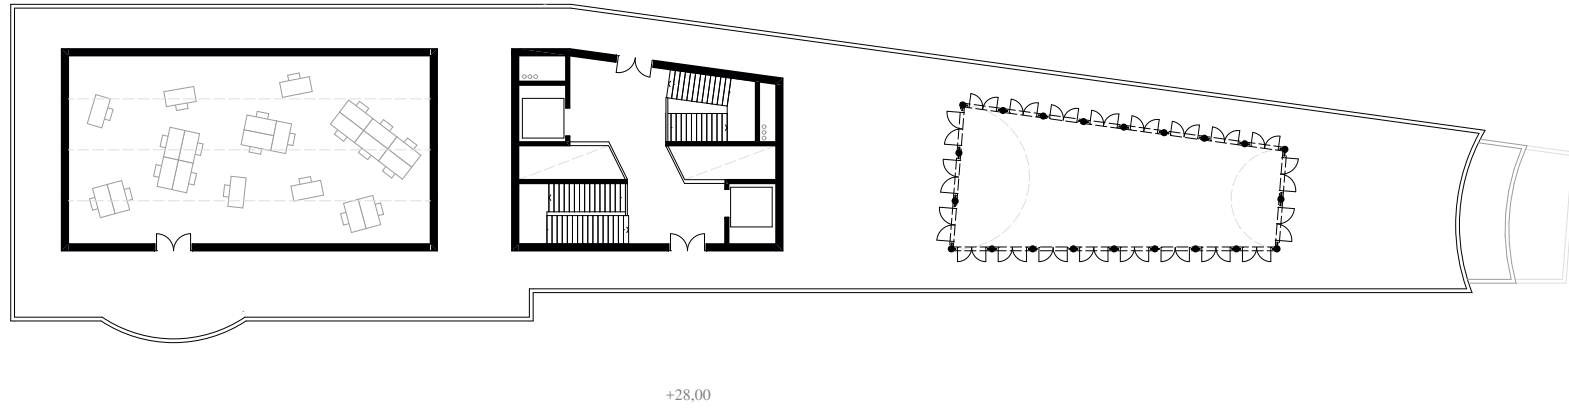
/ Grundriss der Ebene "+28,00" Dachgeschoß M 1:400 (Plan erstellt von PB)
